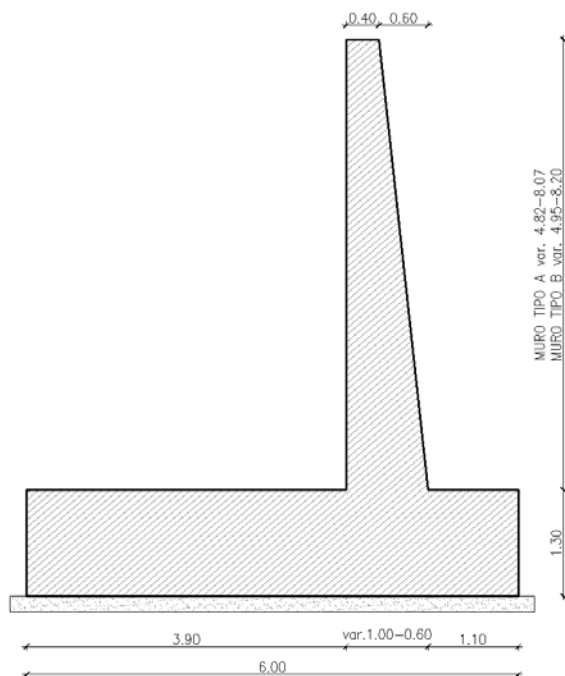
Sezione Muro – prosecuzione spalla altezza variabile
